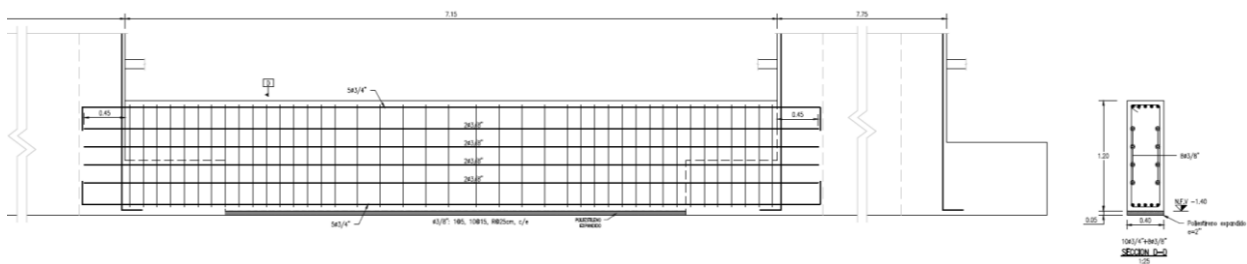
Distribución final de refuerzos en viga de cimentación analizada.
